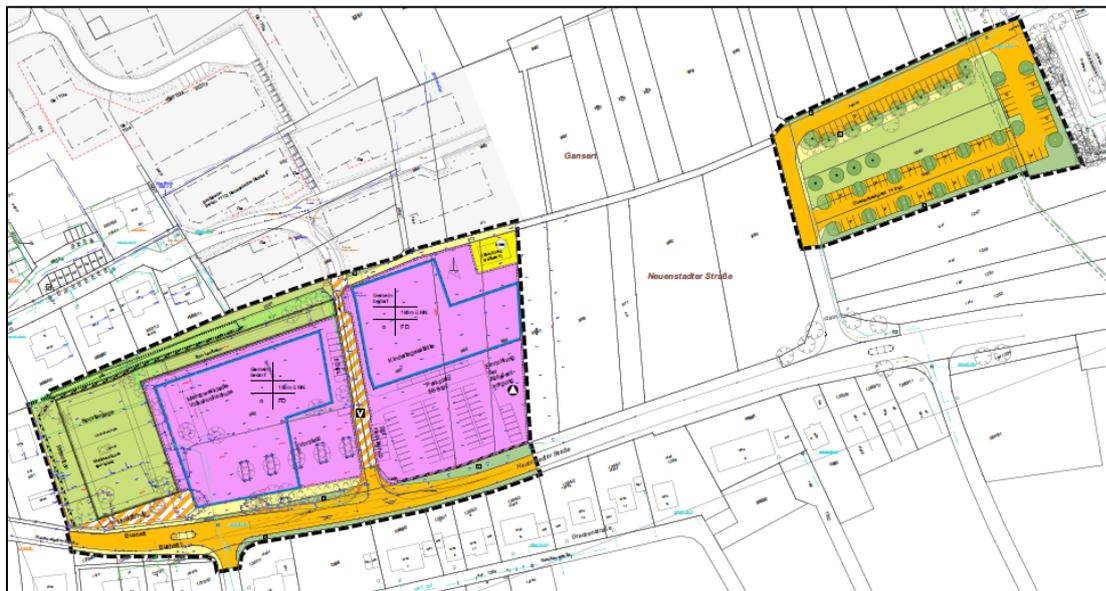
Planzeichnung (ZOLL ARCHITEKTEN STADTPLANER 2022B)
